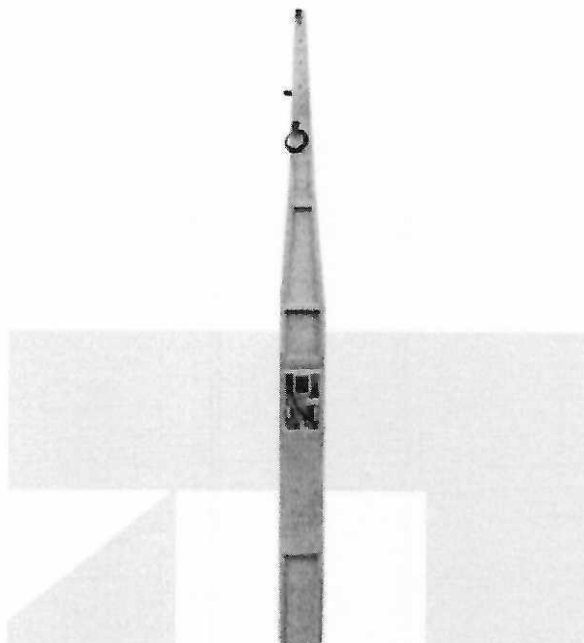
Poste de Concreto Armado Retangular com Medidor.
